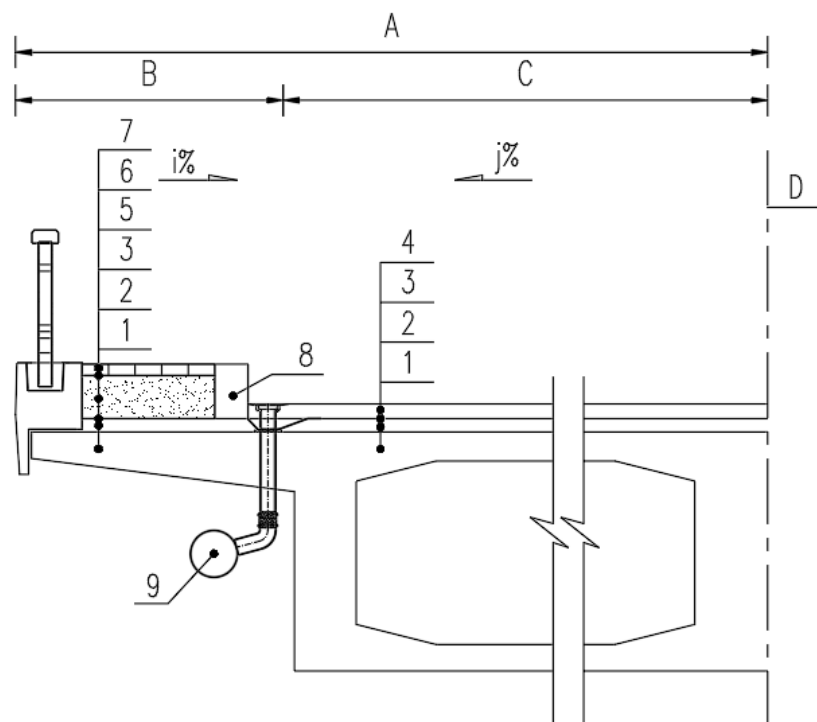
增设填充步道结构承载人行行走的混凝土桥面板结构防水体系示意图
